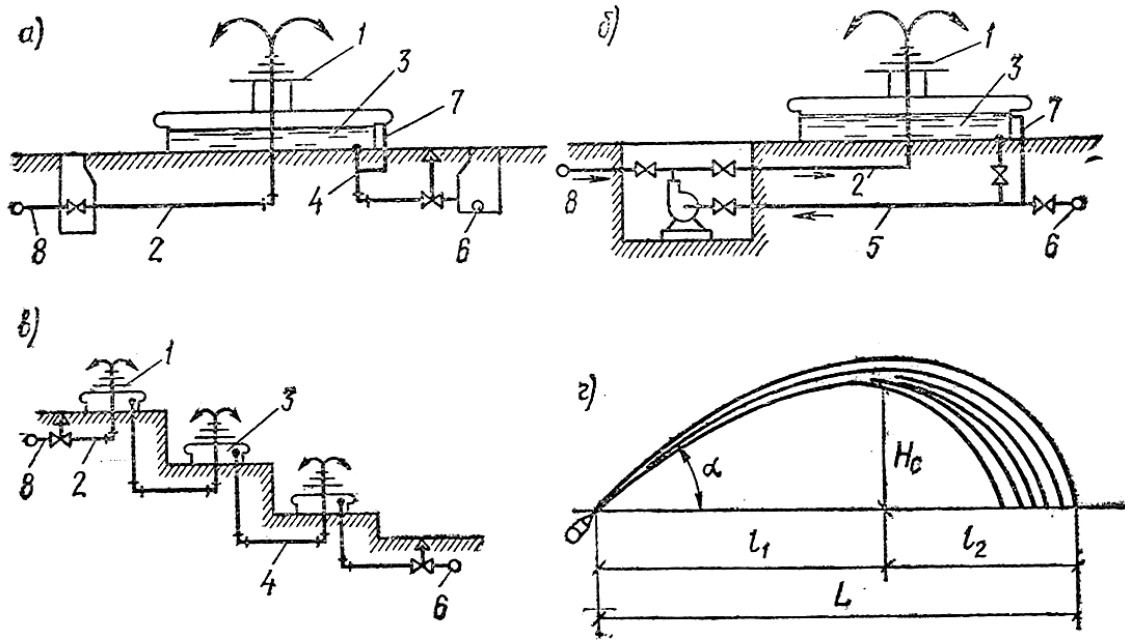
Водоснабжение фонтанов: а – прямоточная схема водоснабжения; б – обратная схема водоснабжения; в – каскадная схема; г – схема струи (к расчету); 1 – распределительная сеть с насадками; 2 – главный трубопровод; 3 – чаша фонтана; 4 – спускной трубопровод; 5 – обратный циркуляционный трубопровод; 6 – наружный водосток; 7 – перелив; 8 – от городского водопровода
